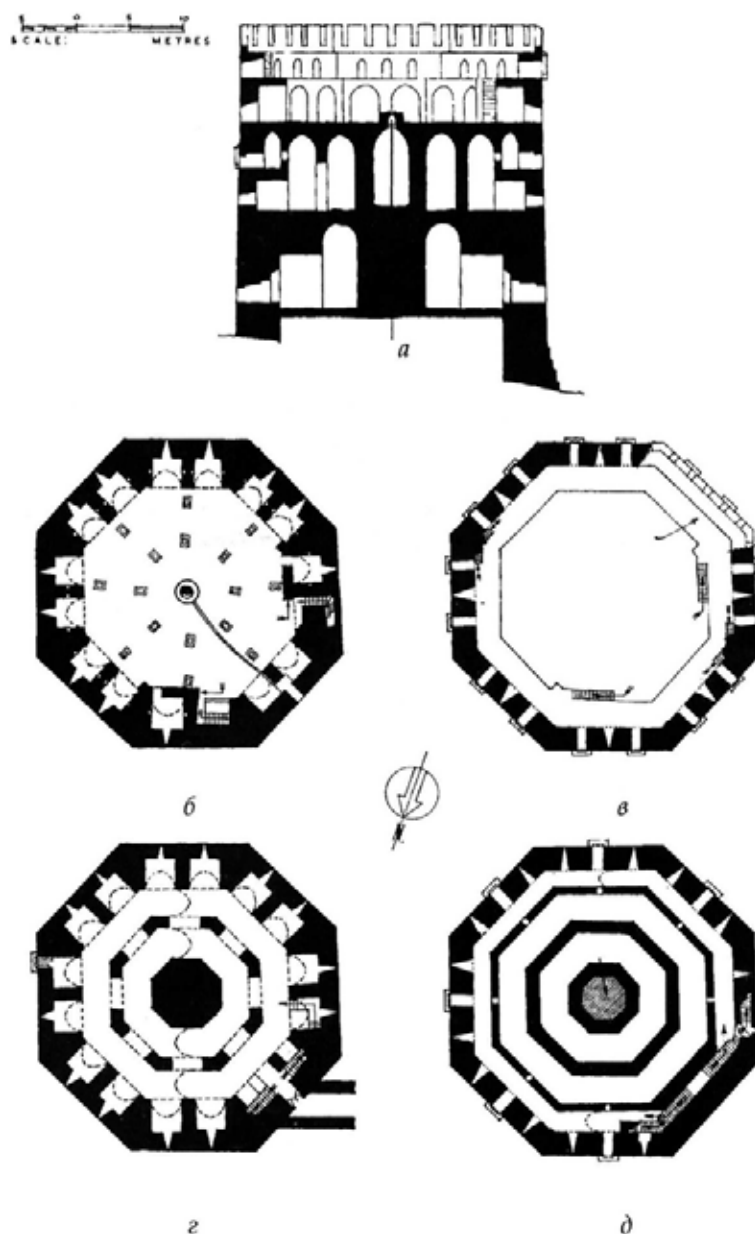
Кизил Куле («Красная башня»), планы башни на различных уровнях, 623/1226 г., Аланья, Турция: а — разрез башни; б — план верхнего этажа; в — верхняя терраса; г — первый этаж; д — бельэтаж
